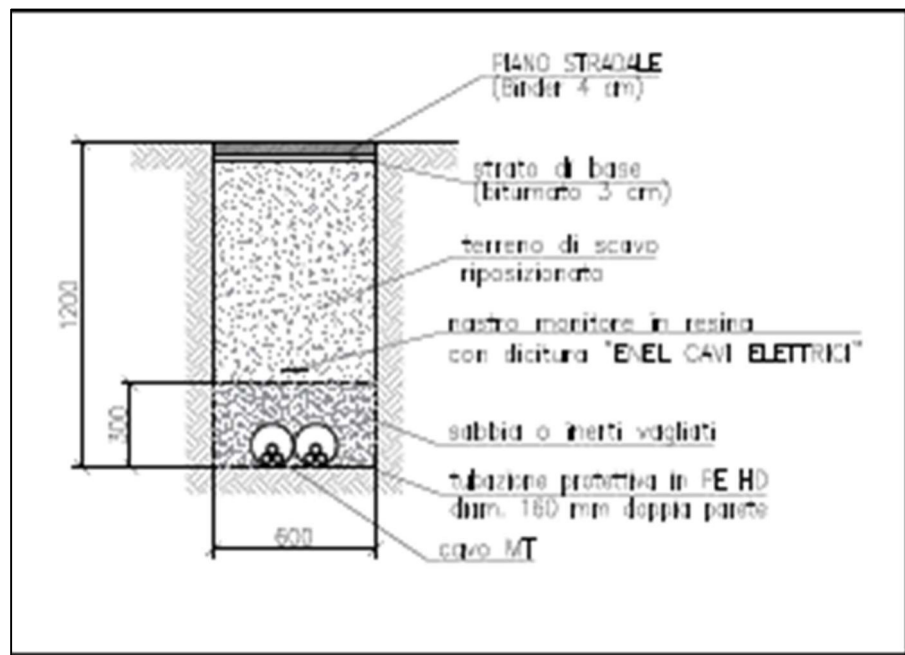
Cavidotto su tracciato asfaltato sezione tipo
